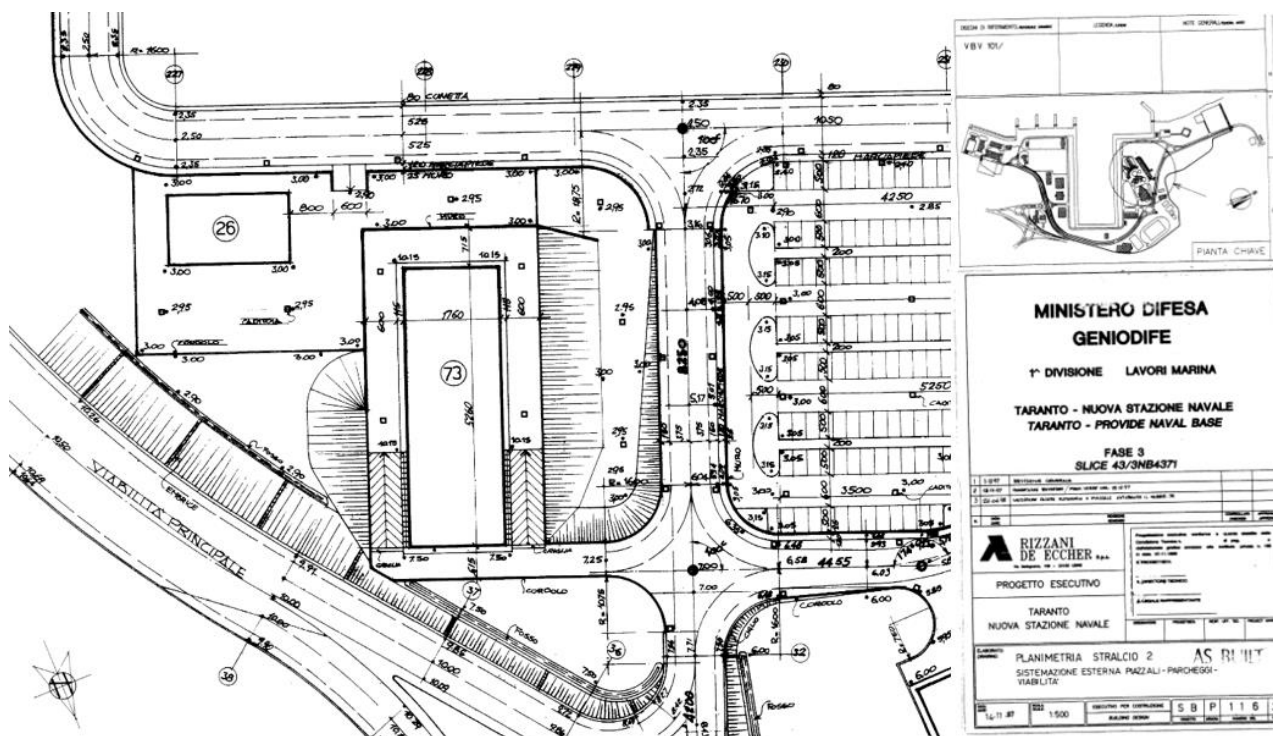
, 5: Stralcio delle planimetrie “Sistemazioni esterna piazzali – parcheggi – viabilità” e “Sistemazioni esterna a verde e pavimentazioni”
